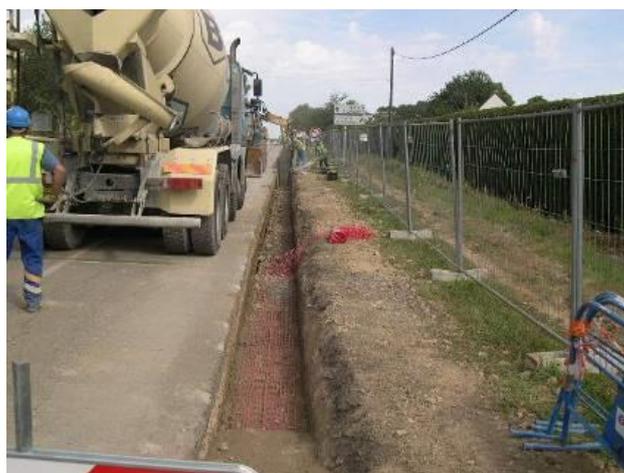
Exemple de signalisation des câbles par un grillage avertisseur
